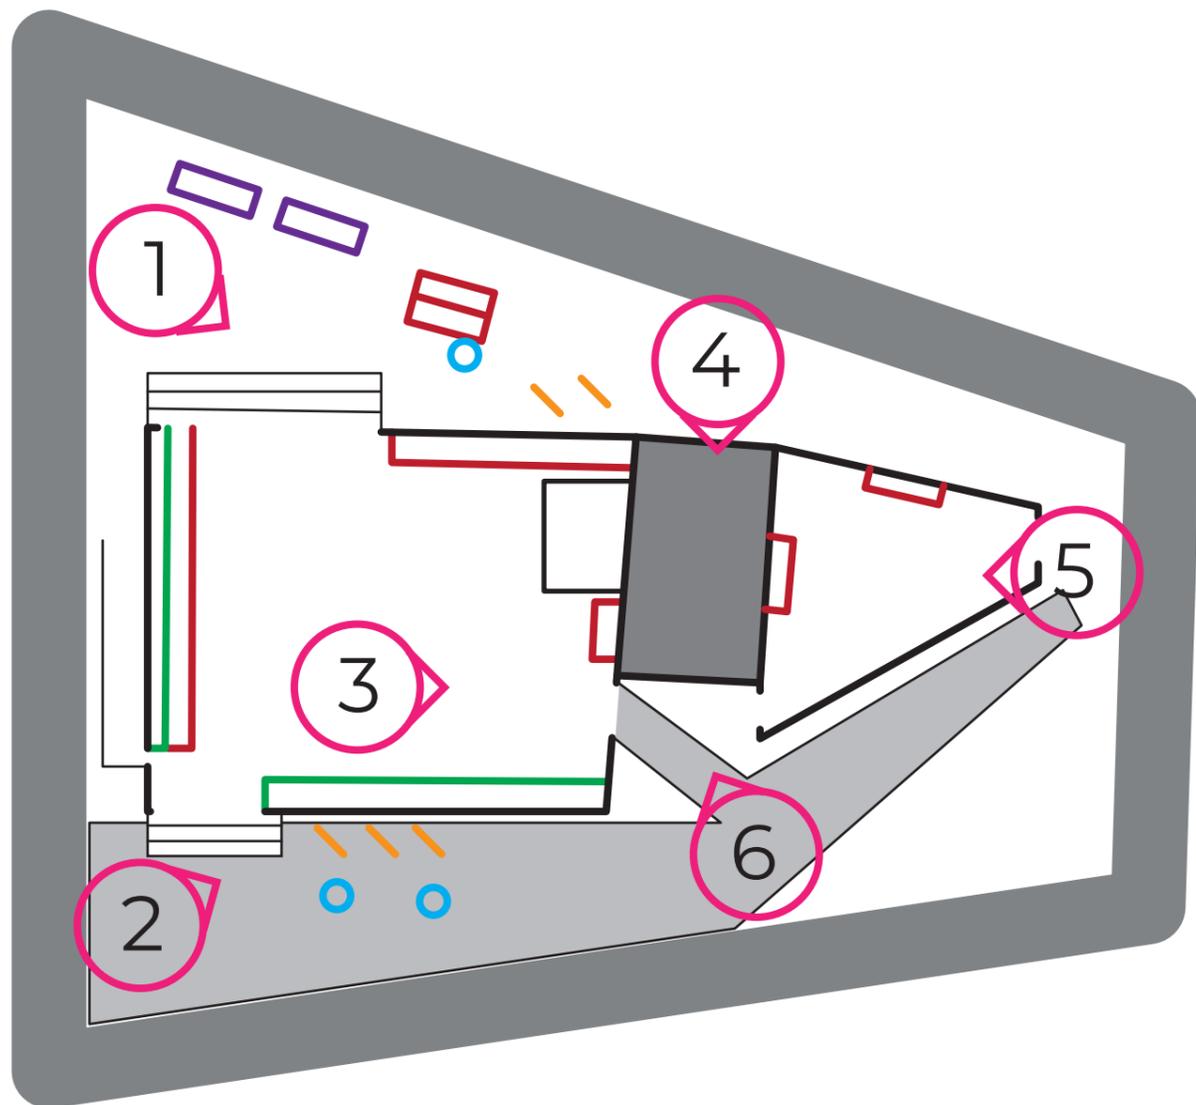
Pianta Place d'Yser con riferimenti fotografici
